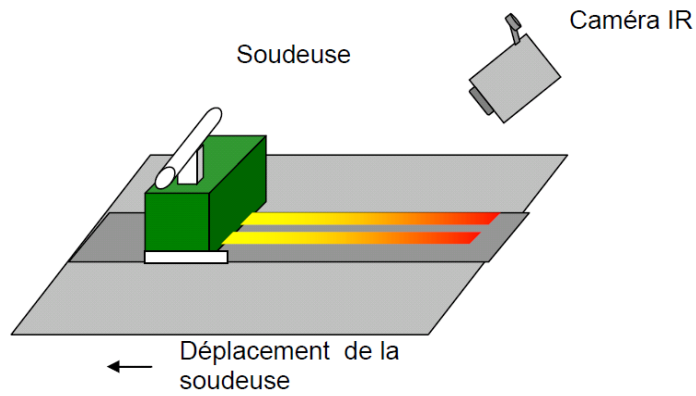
Schéma de principe du contrôle de réalisation de soudure de géomembrane par thermographie IR lors du refroidissement de la soudure.
